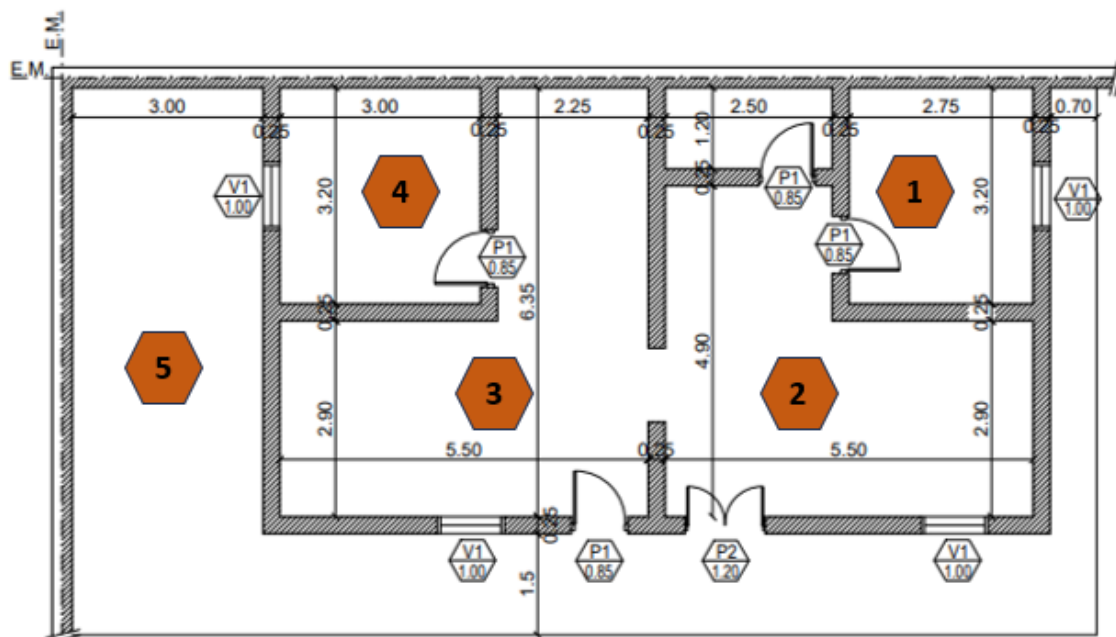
Estructura edilicia de planta productora – Elaboración propia
